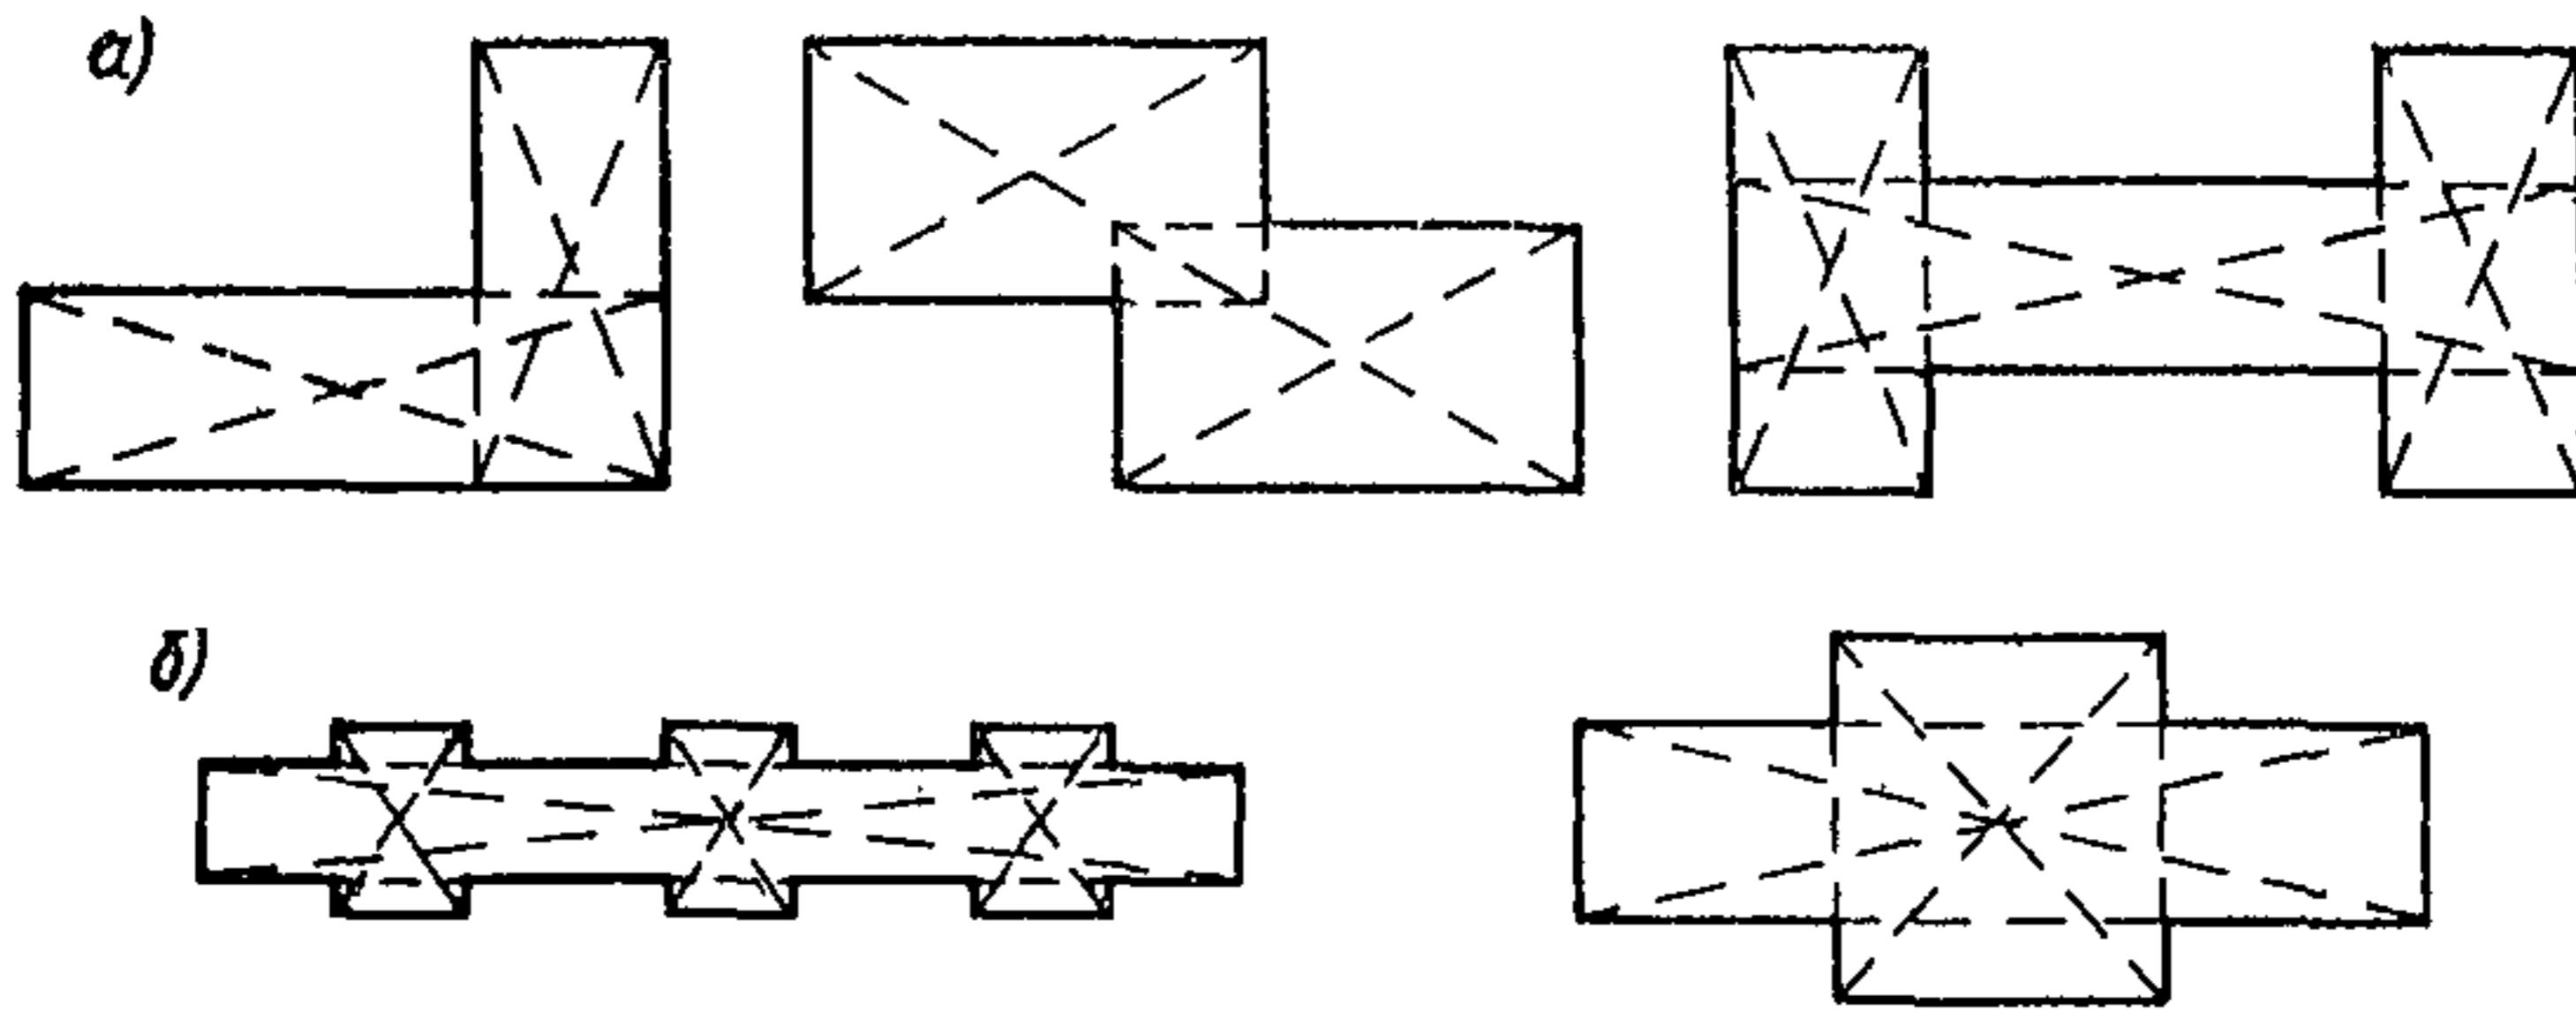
Расчетные схемы плит сложной формы в плане (составленных из прямоугольников)
